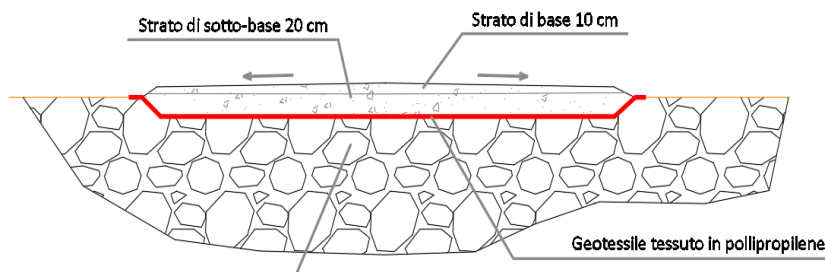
Sezione trasversale tipo della viabilità interna al sito
